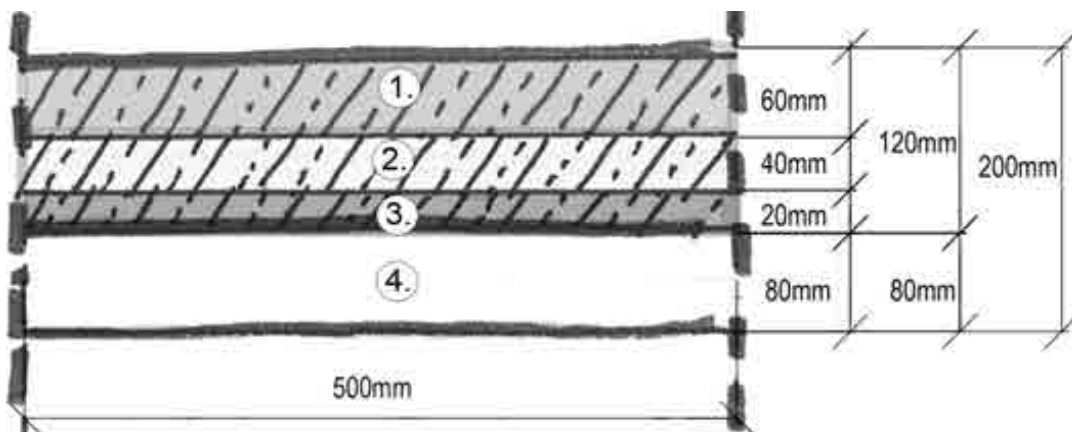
Durchschnittliche Betonmenge, = 120mm Beton Bestand, die kann als Vorlage gestellt werden, Hohlraumdecke Bestand\_20cm\_6cm
